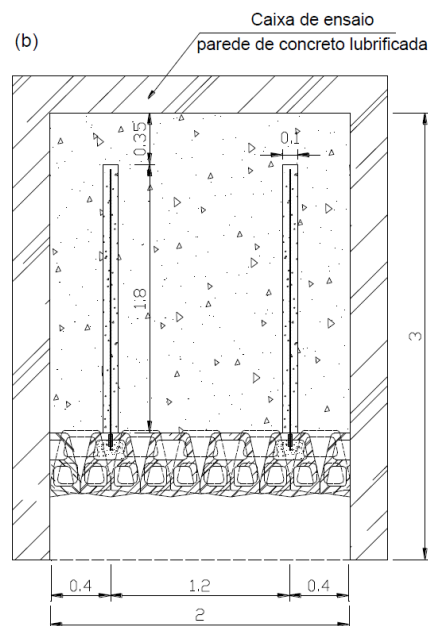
Modelo de solo grampeado – Planta (SILVA, 2010)
